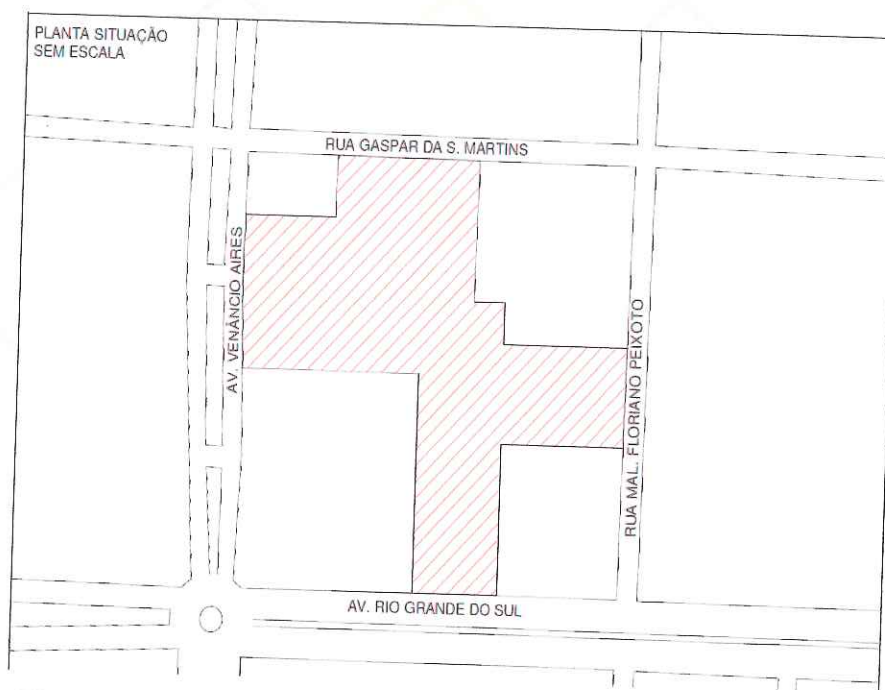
Planta de situação dos lotes do Hospital Regional Unimed Missões.
